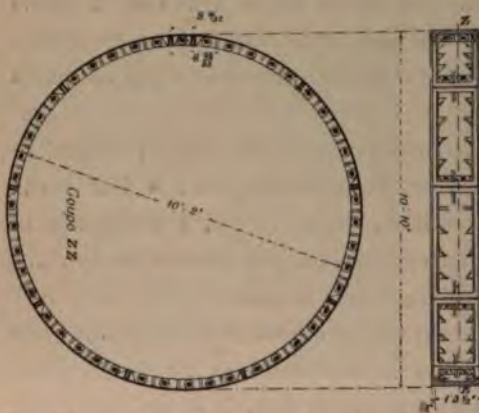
Coupes transversale et longitudinale du revêtement en fonte.
